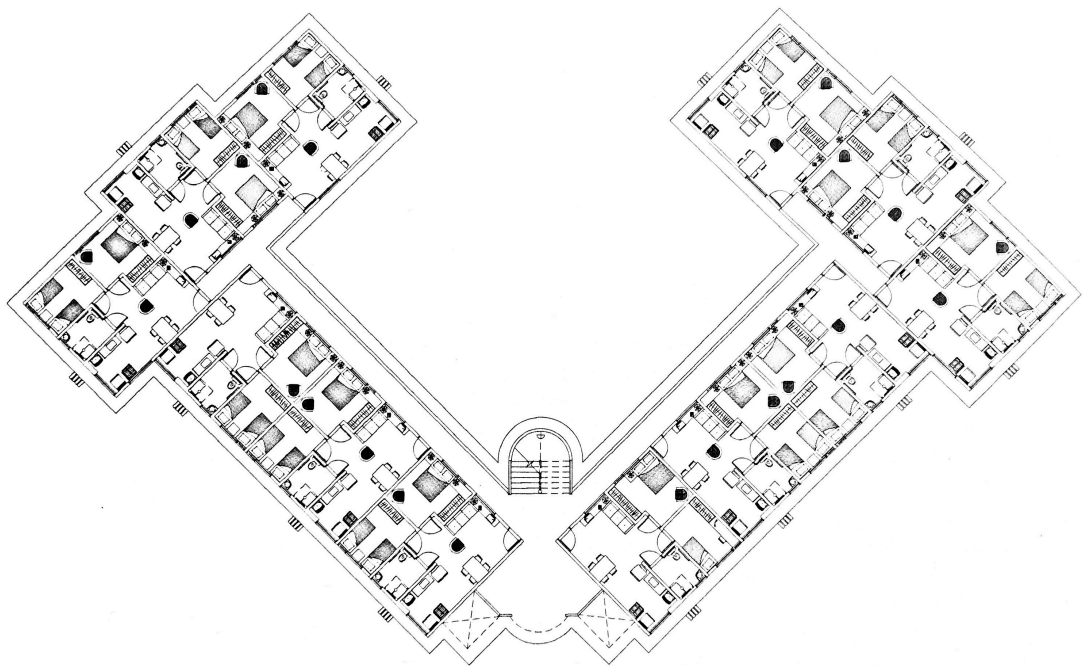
Planta baixa do empreendimento AUTOGRAFICS
